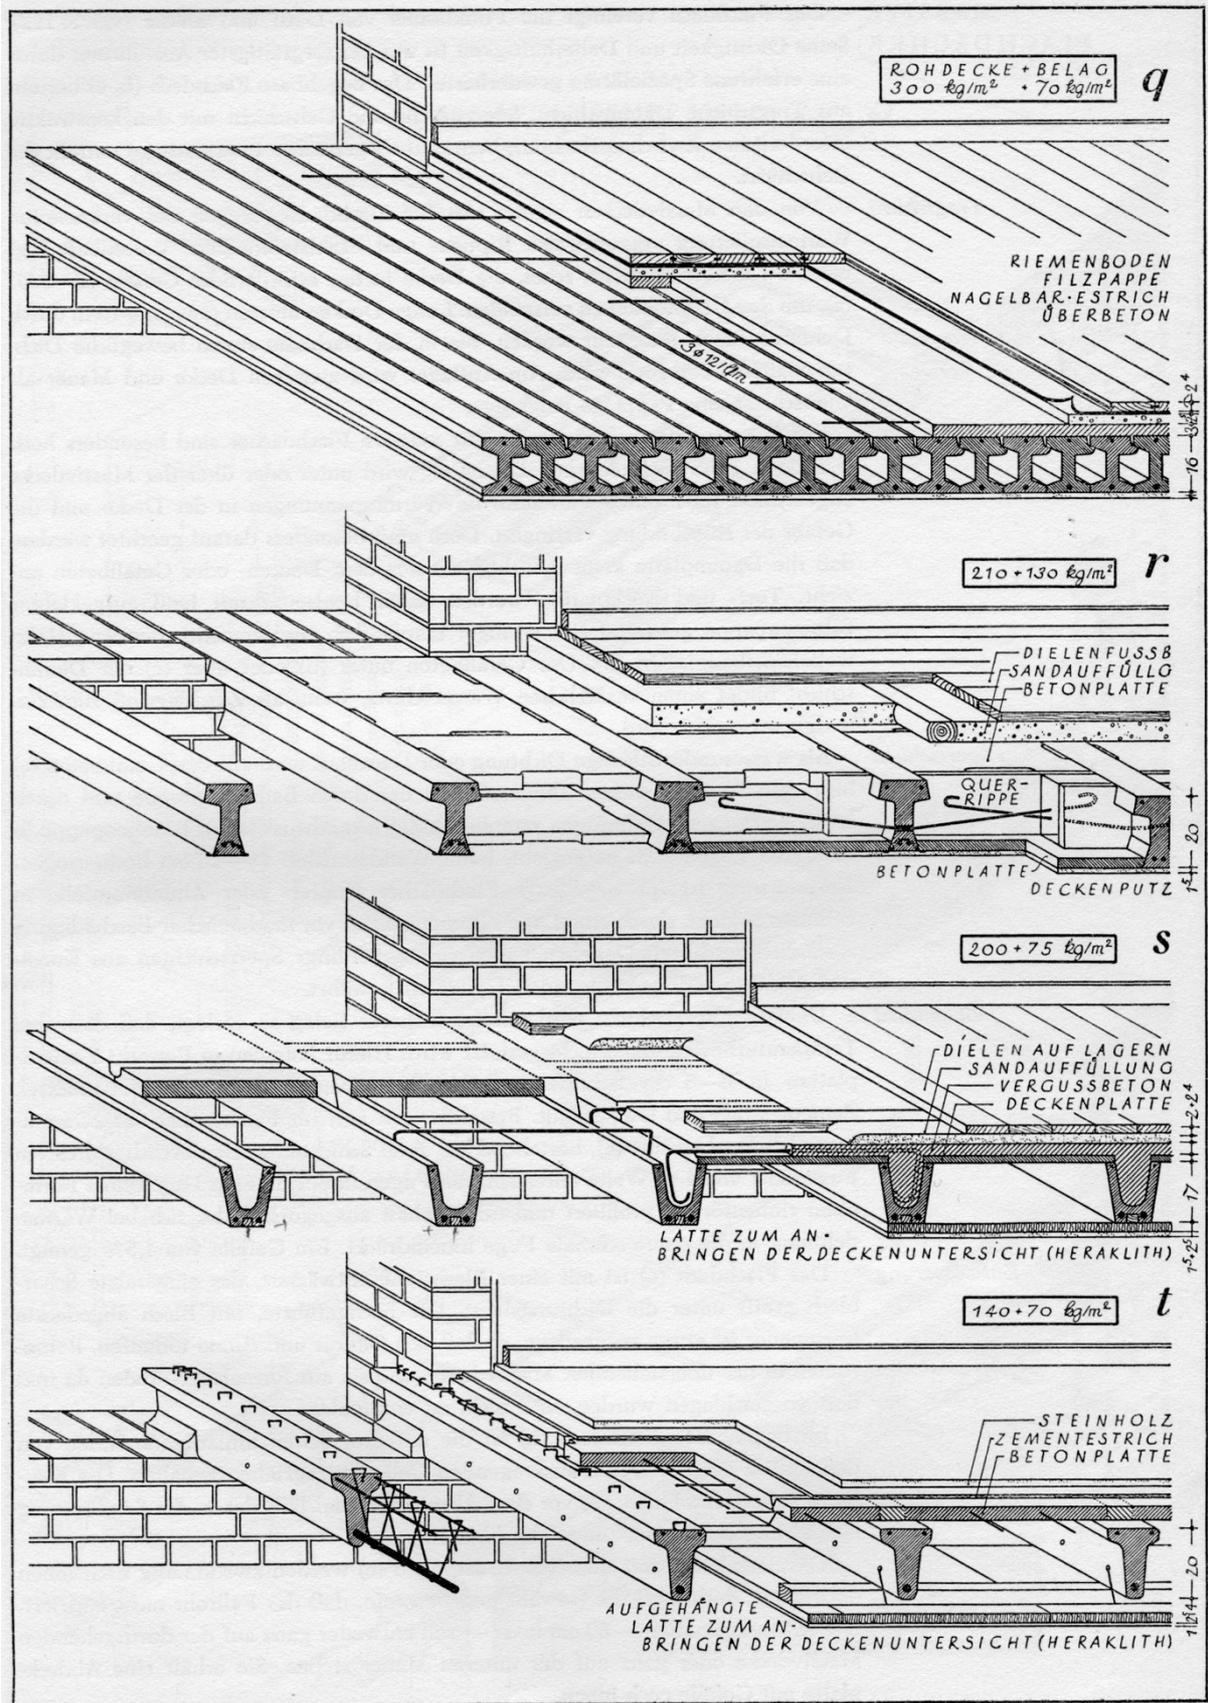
Fertigbalkendecken aus Franz Hart, Baukonstruktion für Architekten, 1950
